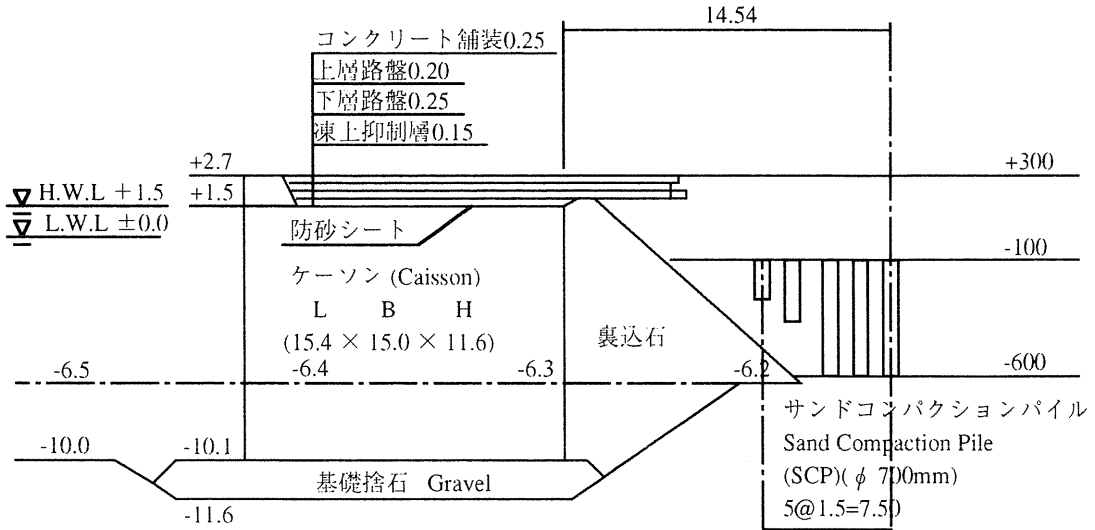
花咲港地区B東岸壁の重力式ケーソン標準断面図
